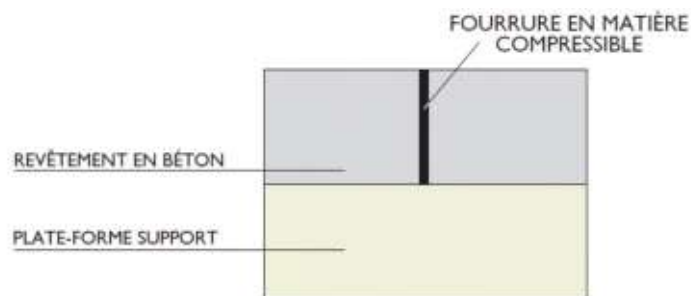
Schéma d'un joint de dilatation (source CimBéton).
